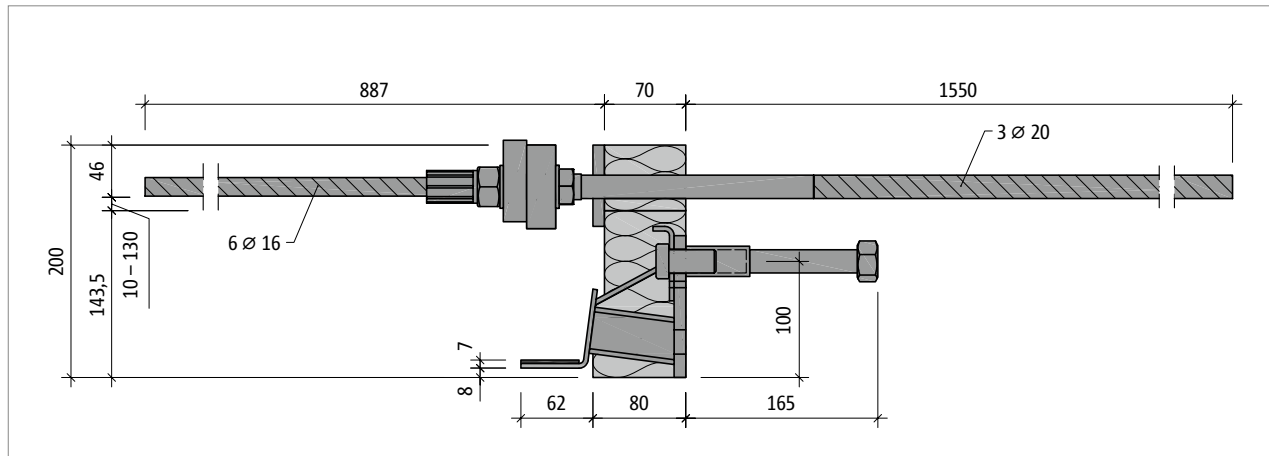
Schöck Isokorf® IQ type K-A: Bovenaanzicht
